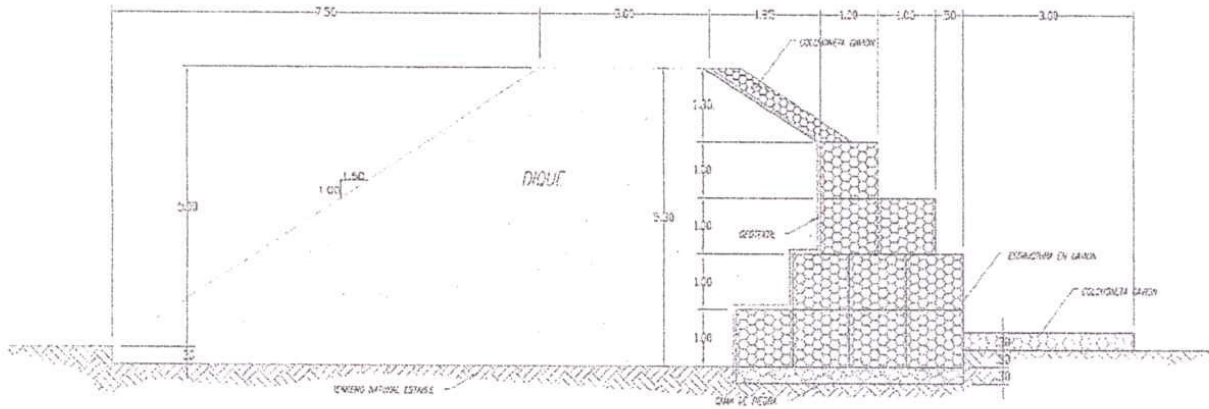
Sección típica propuesta por Interventoria para garrapata 1. Protección con gaviones.
